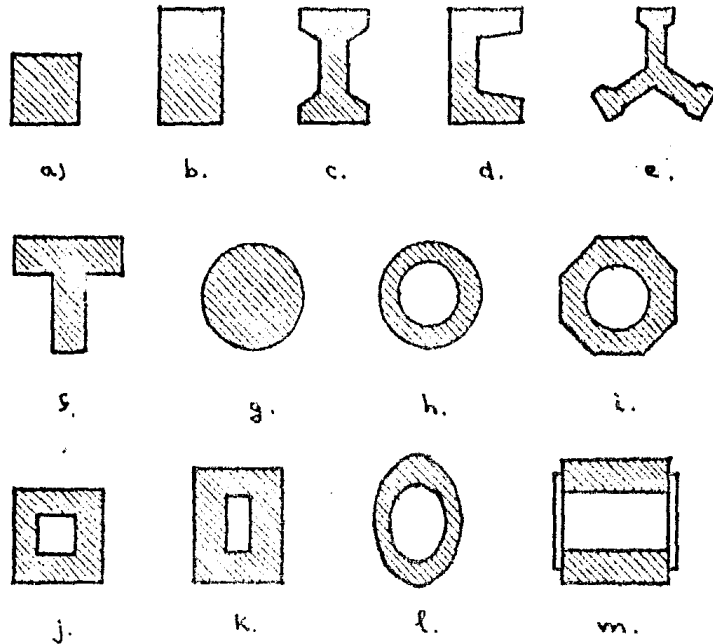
Secciones de postes hechos de concreto presforzado.
